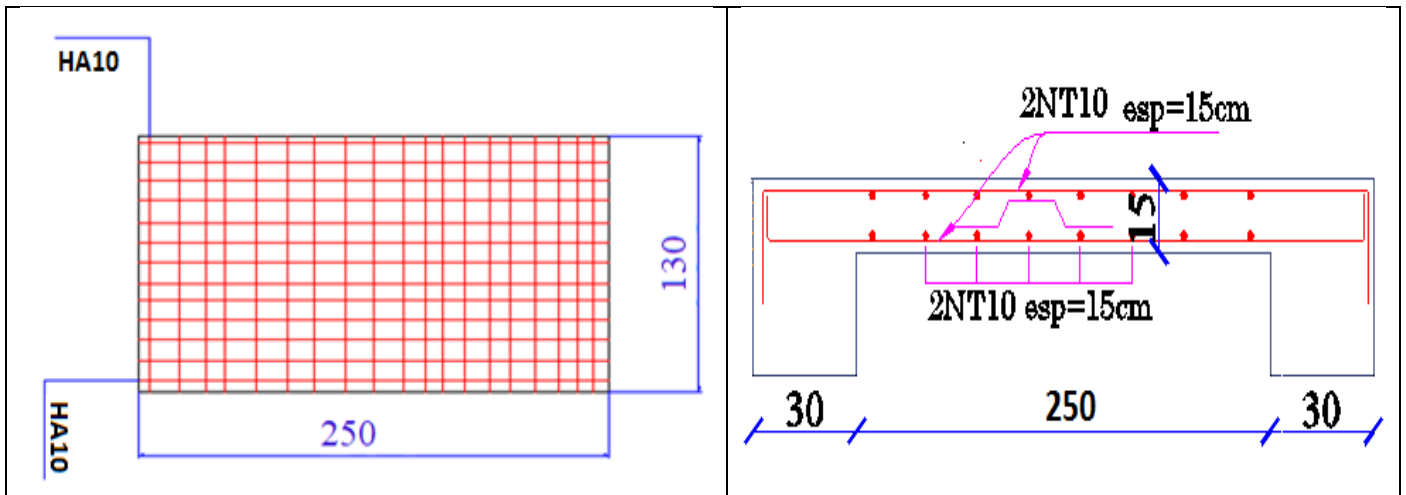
schémas de ferrailage de la dalle d'ascenseur
